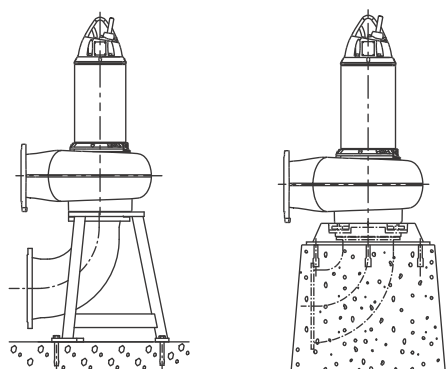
Сухая установка в вертикальном положении на основании (слева) и на плите на двух бетонных стойках (справа)
